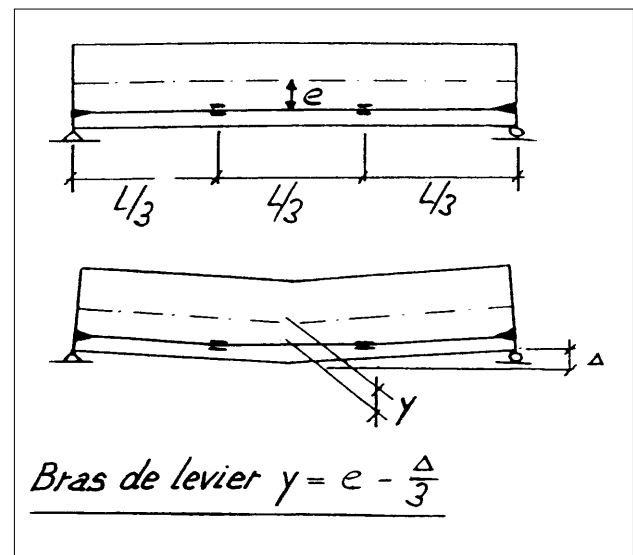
Influence de la déformation d'une poutre sur l'excentricité d'un câble rectiligne lié, en plus des ancrages, par deux bossages de déviation (liaison perpendiculaire à l'axe de la poutre).
